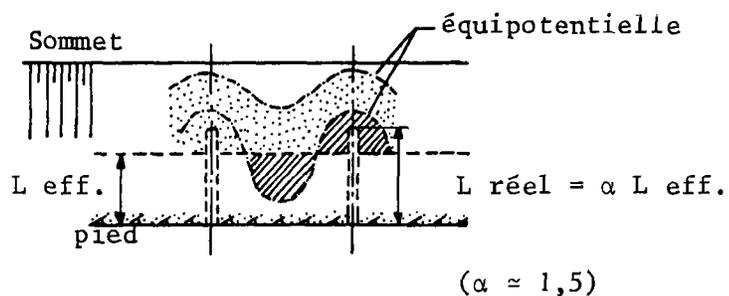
Longueur efficace d'un réseau de drains parallèles (vue en plan)
